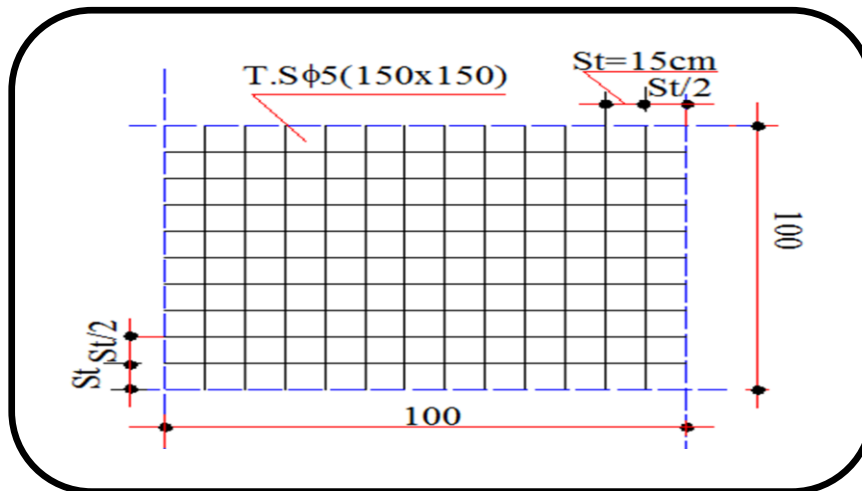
Disposition constructive des armatures de la dalle de compression
